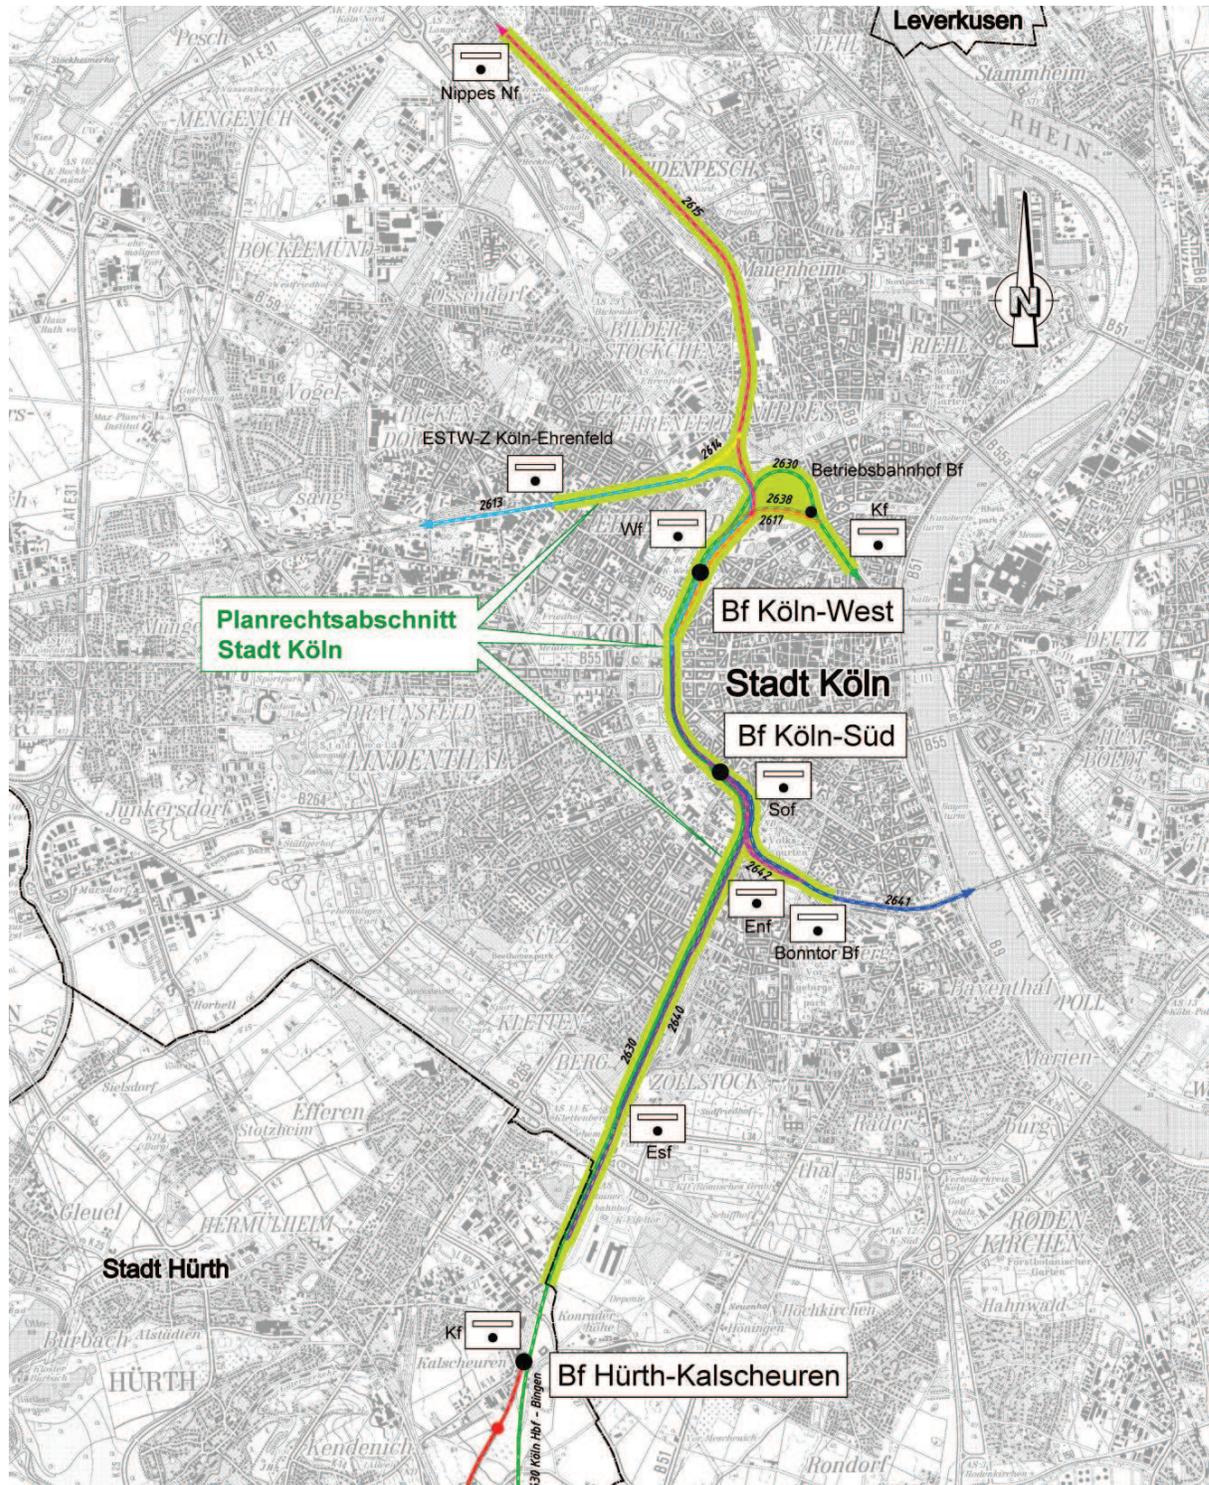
Planrechtsabschnitt „Stadtgebiet Köln“ (Unterlage 2.2 - Übersichtslageplan)
